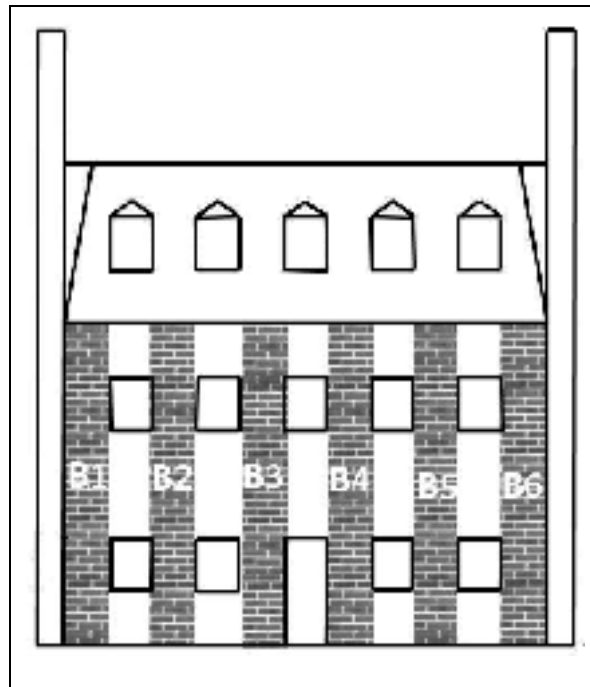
Représentation des pans de murs de façade considérés sur toute leur hauteur (FPH)
